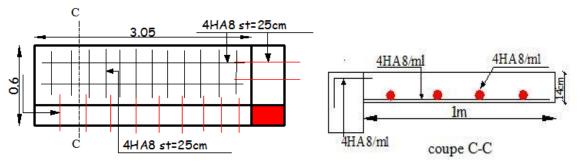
schéma de ferraillage de la dalle 3 et sa coupe C-C.
